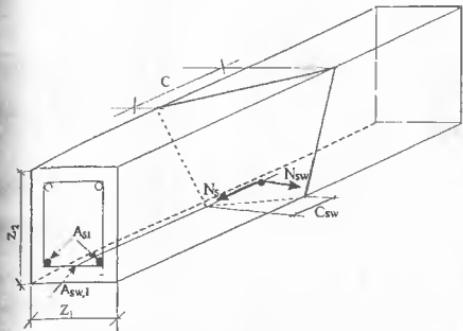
Схема усилий в пространственном сечении при расчете на действие крутящего момента (растянутая арматура у нижней грани элемента)
